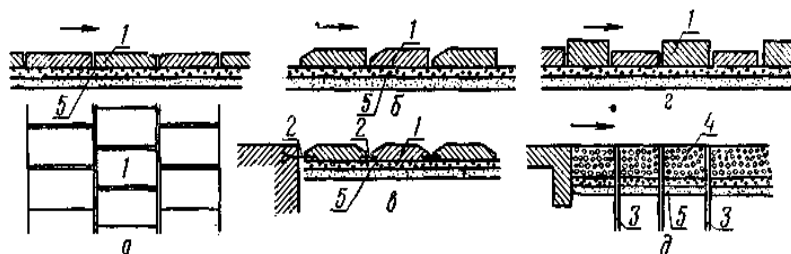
Крепление рисбермы: *a* – плоские плиты; *б* – плиты со скошенными ребрами; *в* – шарнирно связанные плиты (ковёр из плит); *д* – плиты разной высоты (повышенная шероховатость); *д* – каменная наброска между сваями, забитыми в шахматном порядке; *1* – плиты; *2* – анкерные связи между плитами; *3* – сваи; *4* – каменная наброска; *5* – слой обратного фильтра
